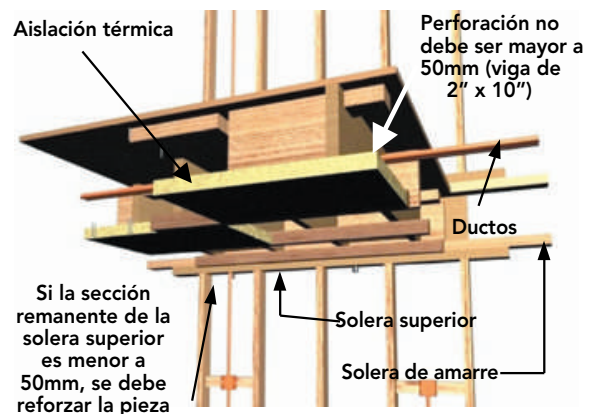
19: La perforación en soleras debe efectuarse en el eje central, con un diámetro no mayor de 1/3 del ancho de la pieza.
